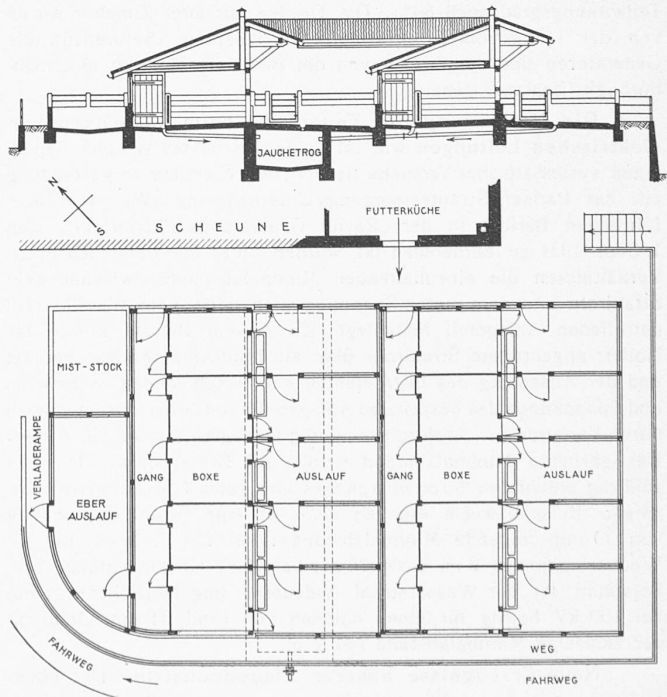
Grundriss und Schnitt der Schweineställe. — Masstab 1 : 250.
